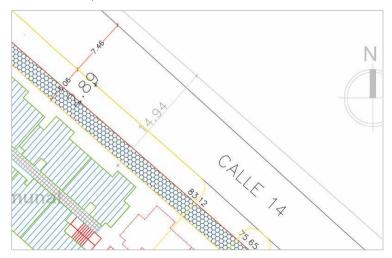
Construcción de la calle 14 entre carrera 37 y carrera 36 Fuente: Estudio de Movilidad y Accesibilidad
